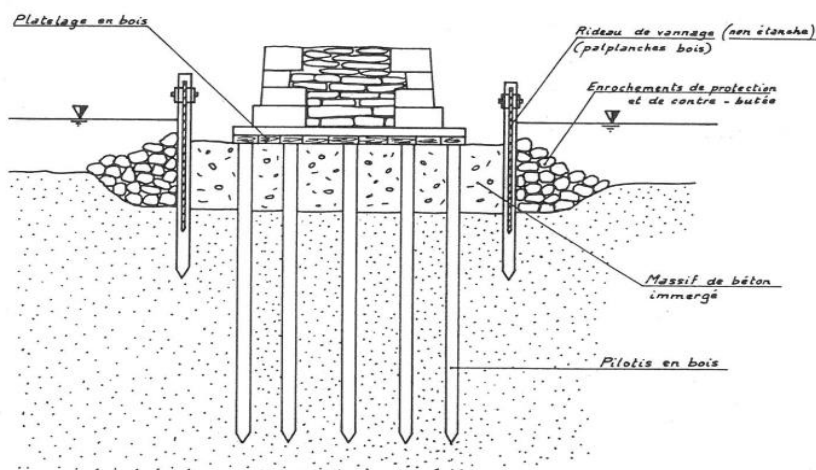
Fondations sur pieux enserrés dans un massif en béton immergé (Levillain, 1980)
